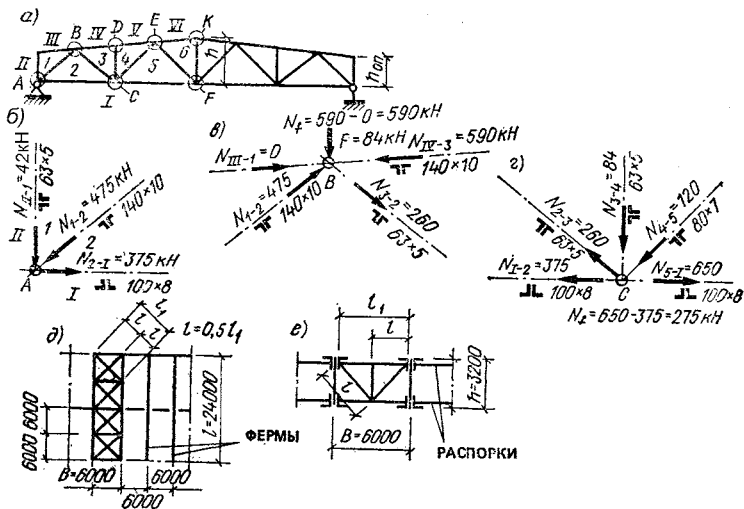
Расчетные схемы узлов стропильной фермы
